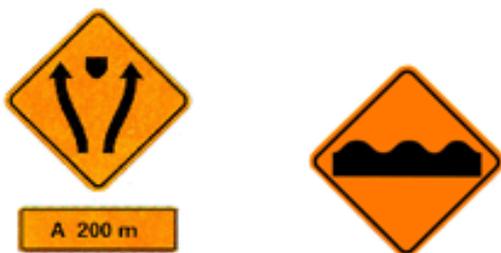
Exemplos de placas de sinalização de obras: início de pista dividida; pista irregular. (Detran)
